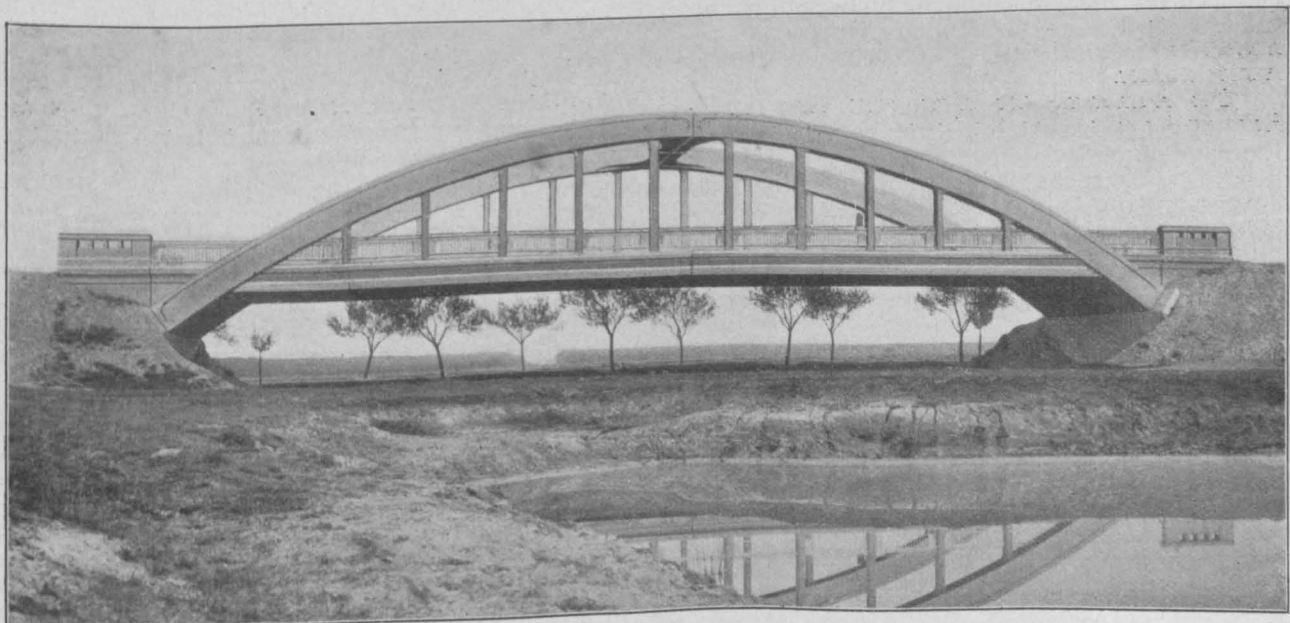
Eisenbeton-Bogenbrücke mit angehängter Fahrbahn über den Ems—Weser-Kanal bei Hannover.
